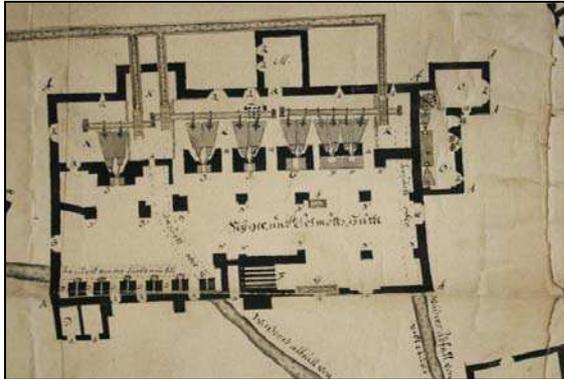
Grundriss der Langen Hütte mit Angaben der technischen Ausstattung (1696)
